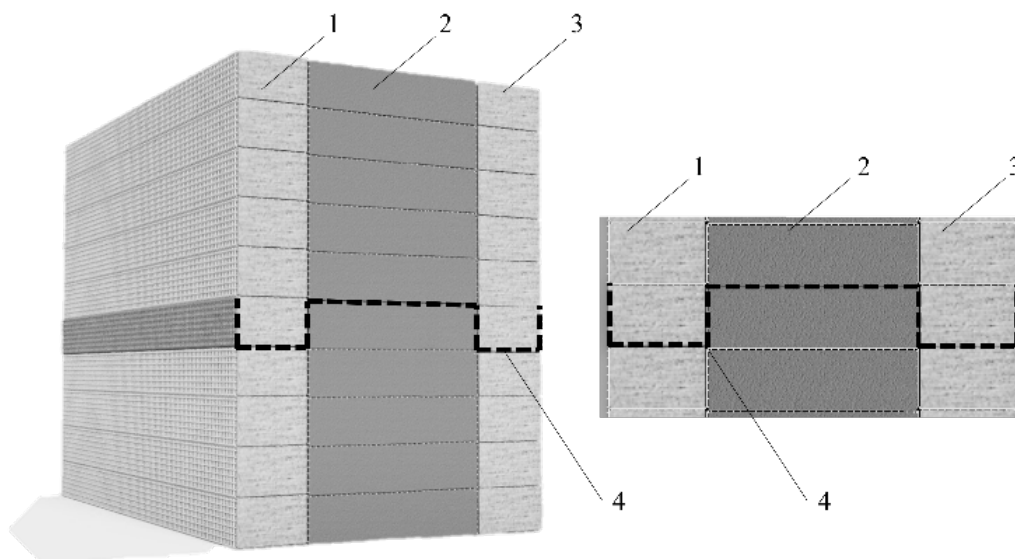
Модель 3D печатной стеновой конструкции: 1 – наружная стена; 2 – теплоизоляционный материал; 3 – внутренняя стена; 4 – армирующий каркас
